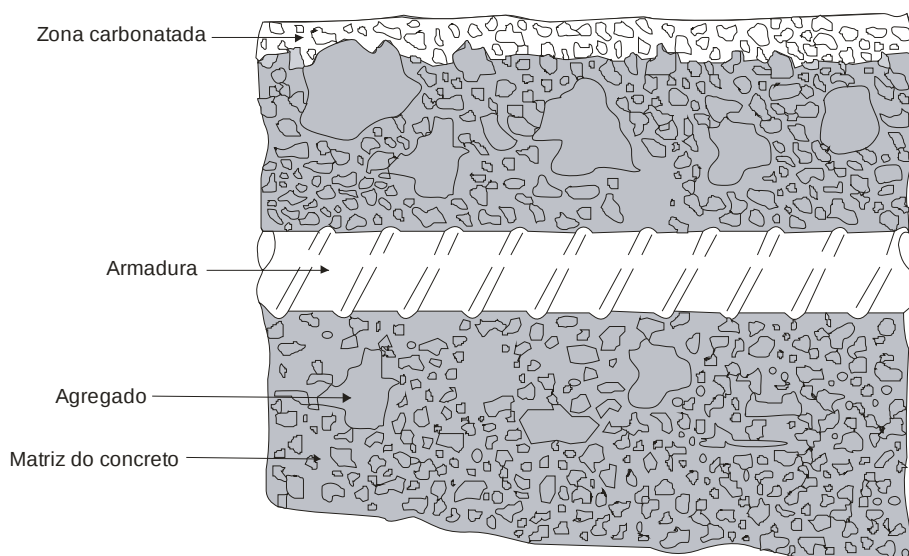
Vista diagramática do início da corrosão da armadura em concreto carbonatado
